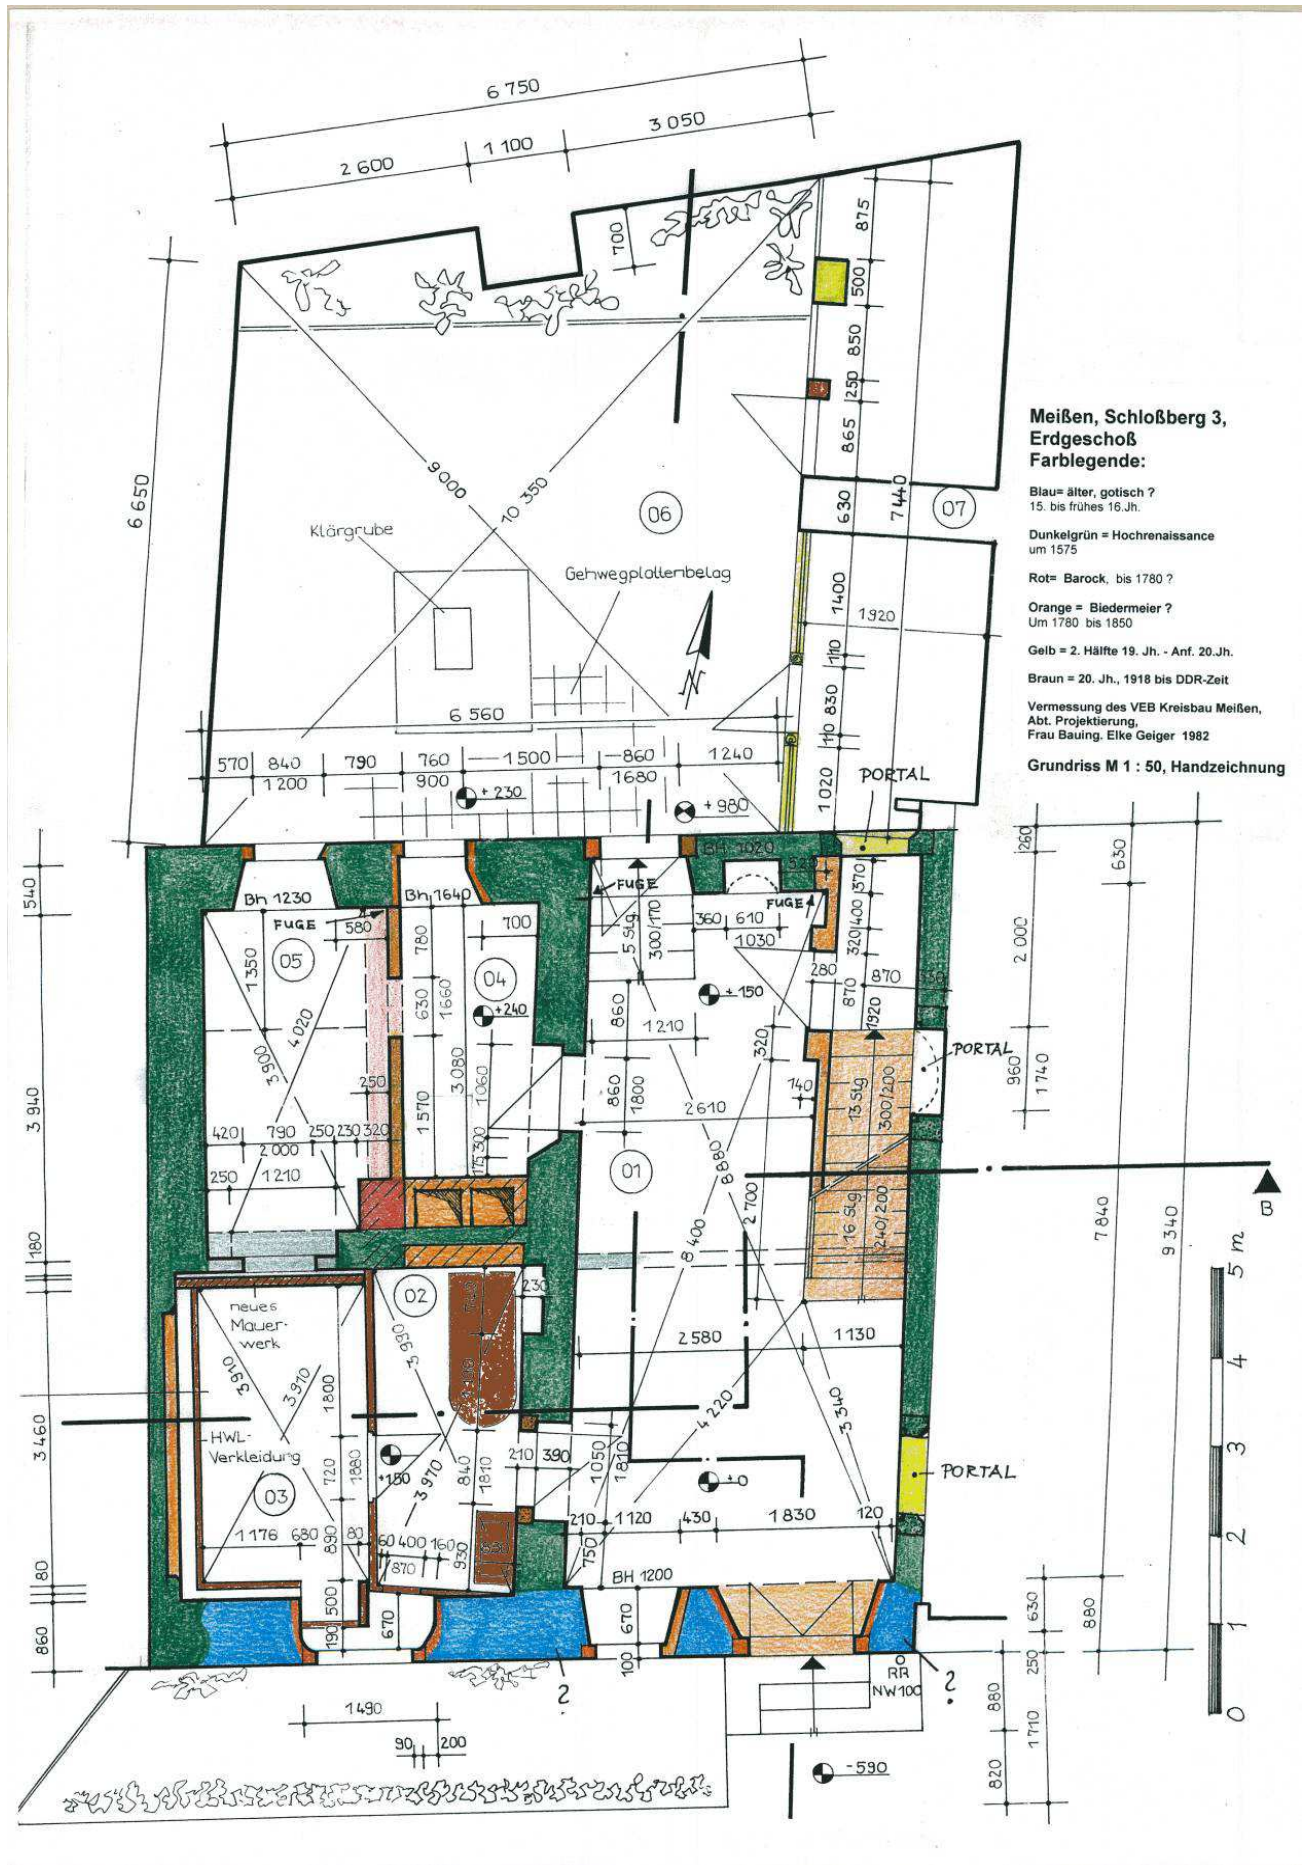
Schlossberg 3, Baualtersplan Erdgeschoß
